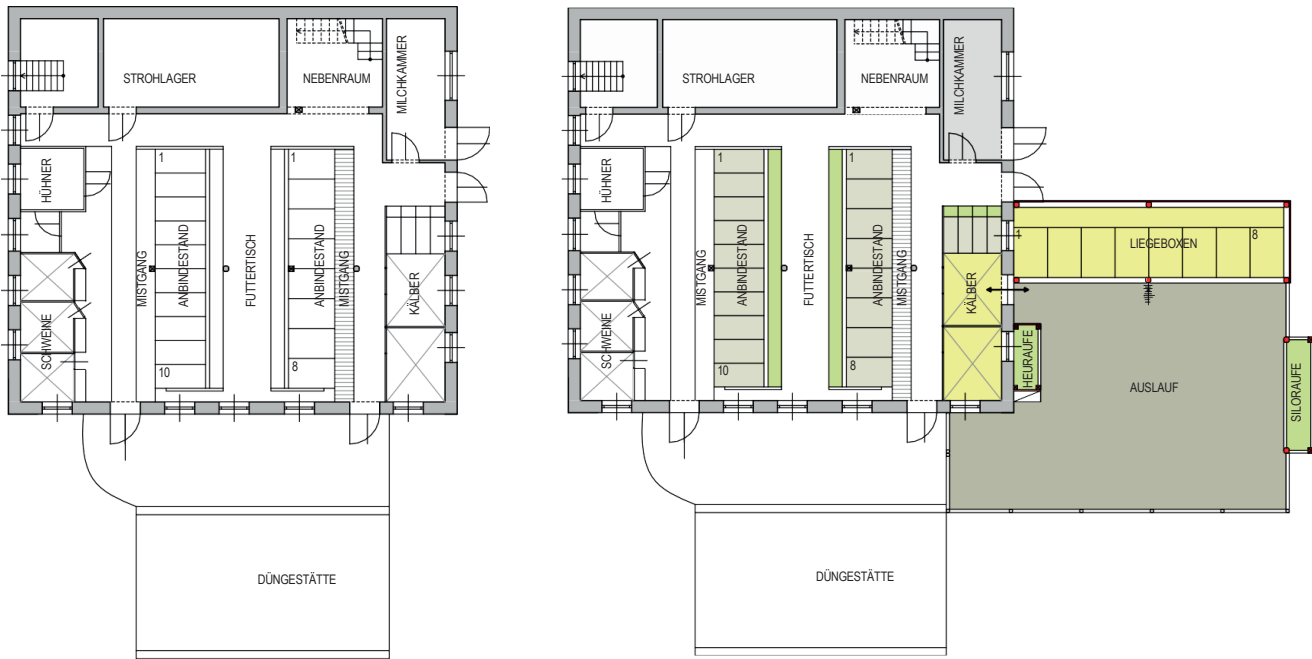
Grundriss vor der Baumaßnahme und Grundriss nach der Baumaßnahme
